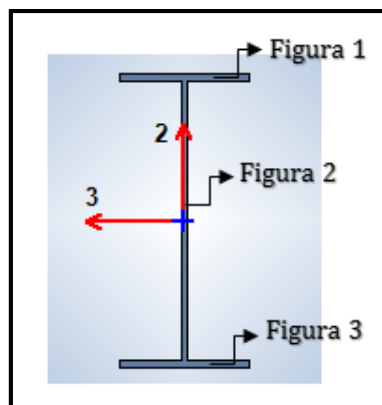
Viga principal 1-2 eje A con pórticos arriostrados, figuras para cálculos.
